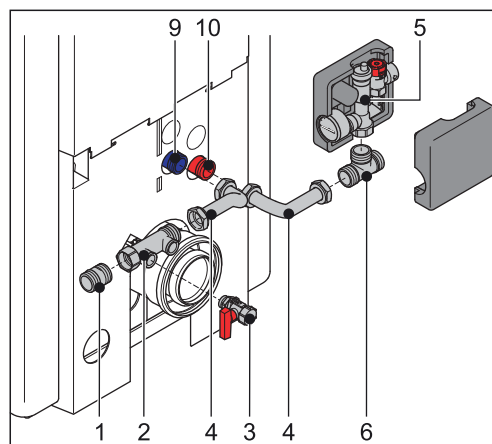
Montaggio gruppo di sicurezza SBG A1 (legenda v. figura 8-1)
